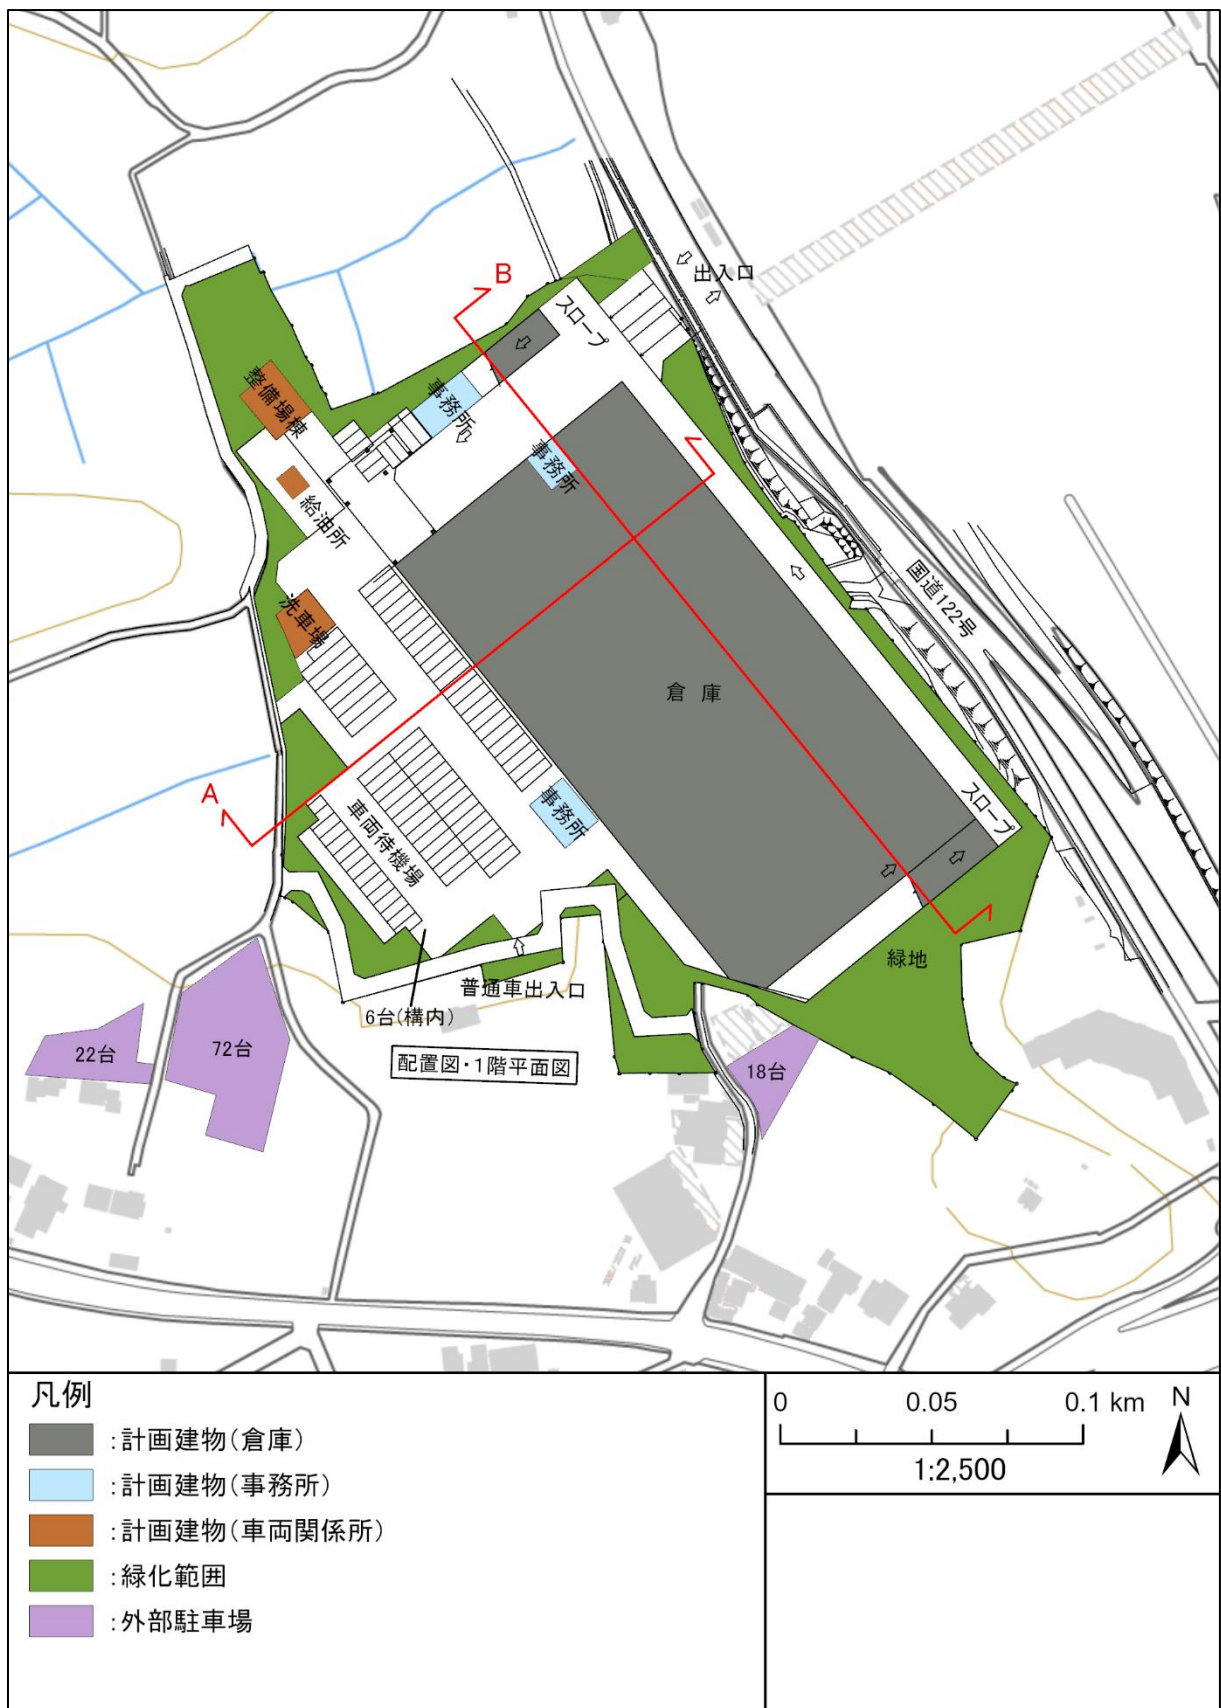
(2) 計画施設の配置計画図および1階平面図(現計画)
